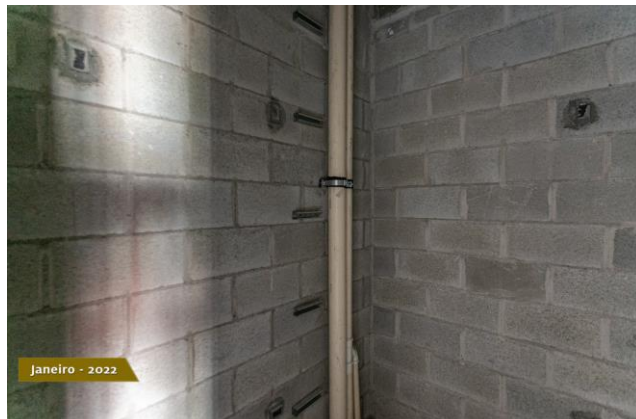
Alvenaria em pavimento finalizada com detalhe para tubulação hidráulica
